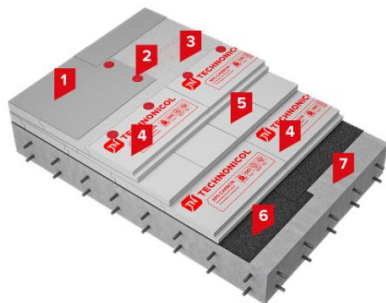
Кровельная система с теплоизоляционным слоем из экструзионный пенополистирола ТН-кровля Проф
